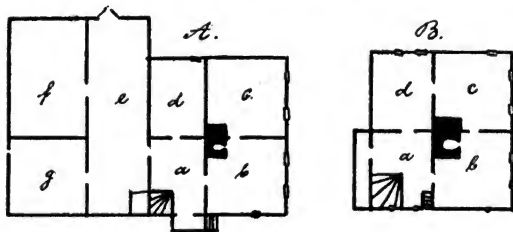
Grundrisse des vorigen Hauses.
